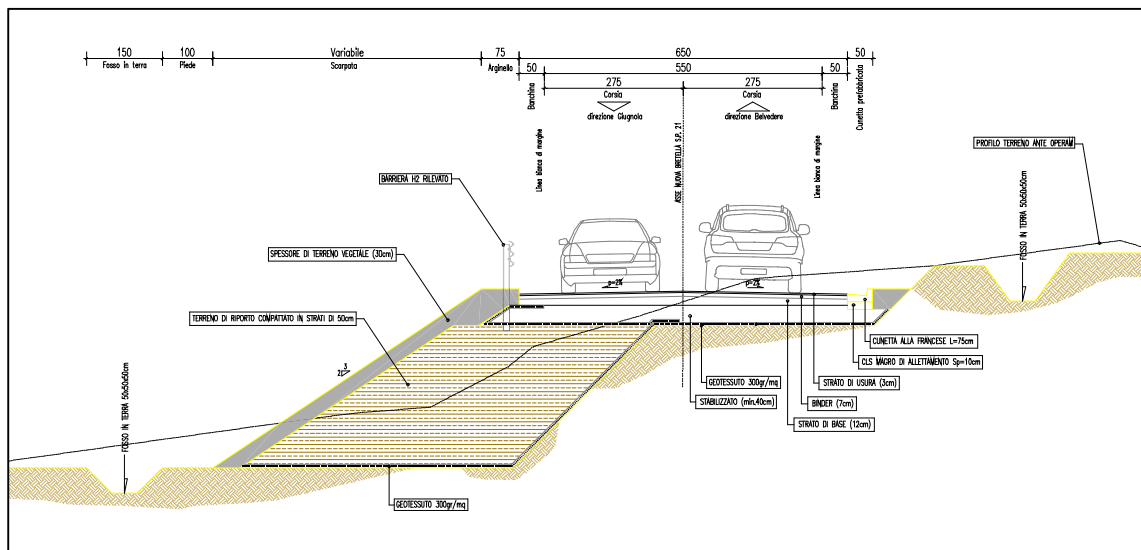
Sezione del rilevato di accesso al ponte in sinistra idraulica2
